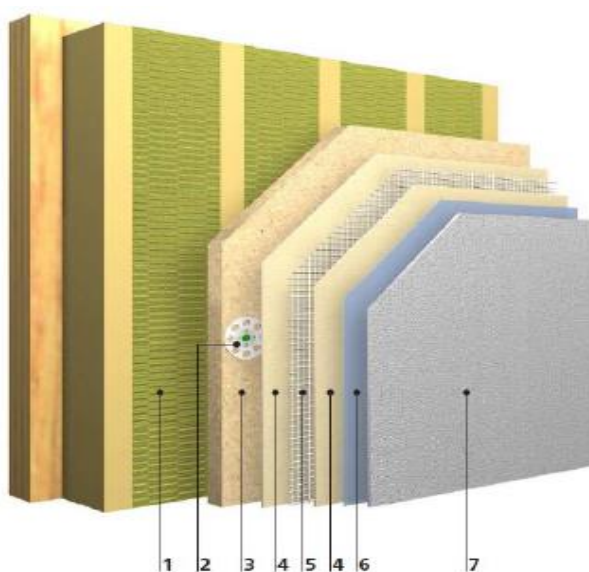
Pormenor do ETICS StoTherm Wood A [57]
